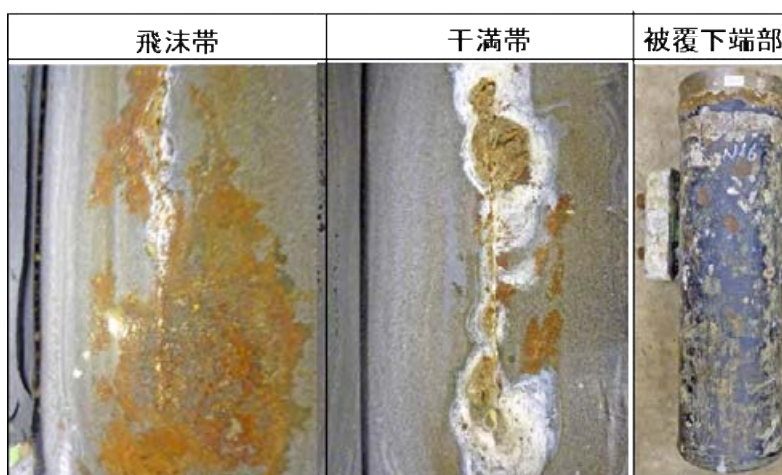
線状傷剥離後の外観と被覆下端部の状況
